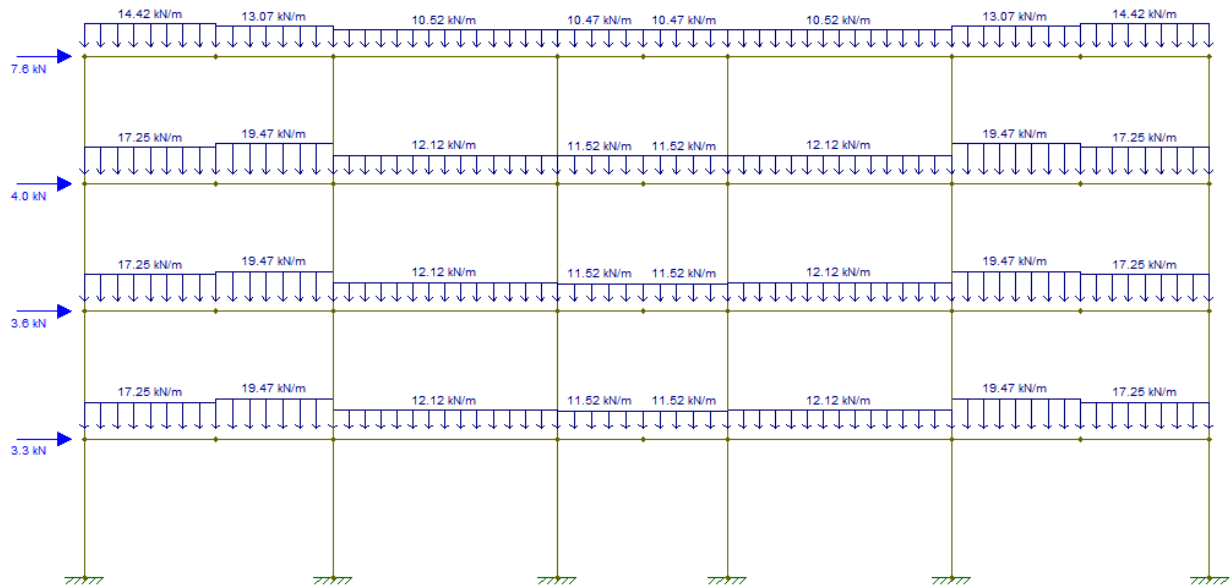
Pórtico 2 carregado, vigas V2 e V3.
